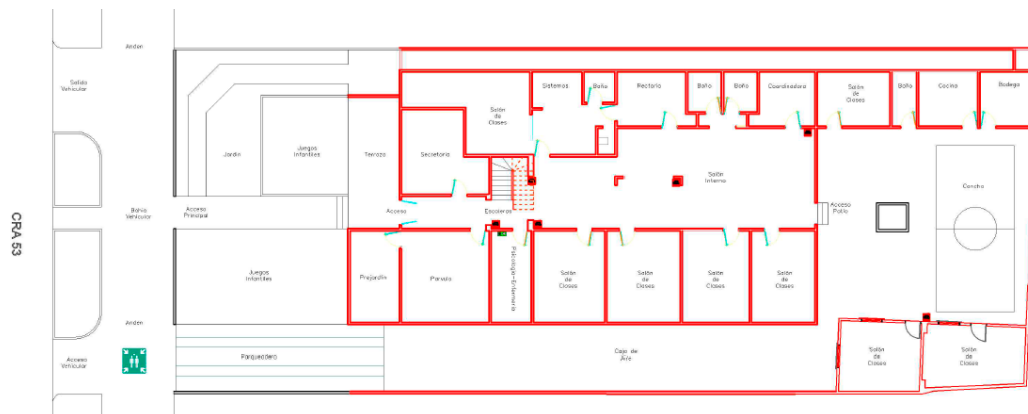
Planta Arquitectónica 1er Piso Actual Jardín Infantil. CAJACOPI.
